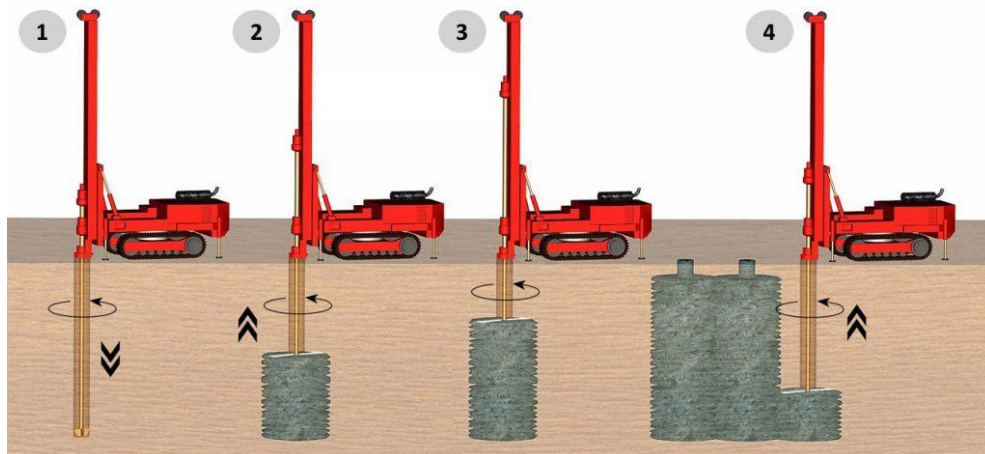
Fases de execução de Jet Grouting. Imagem retirada de <http://www.railsystem.net/jet-grouting/>.
